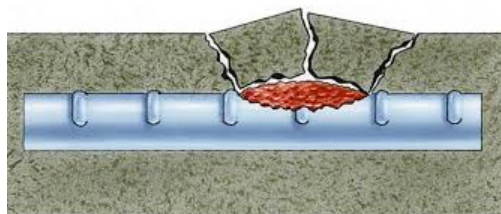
Efecto de la Corrosión en Varillas para la Construcción.
